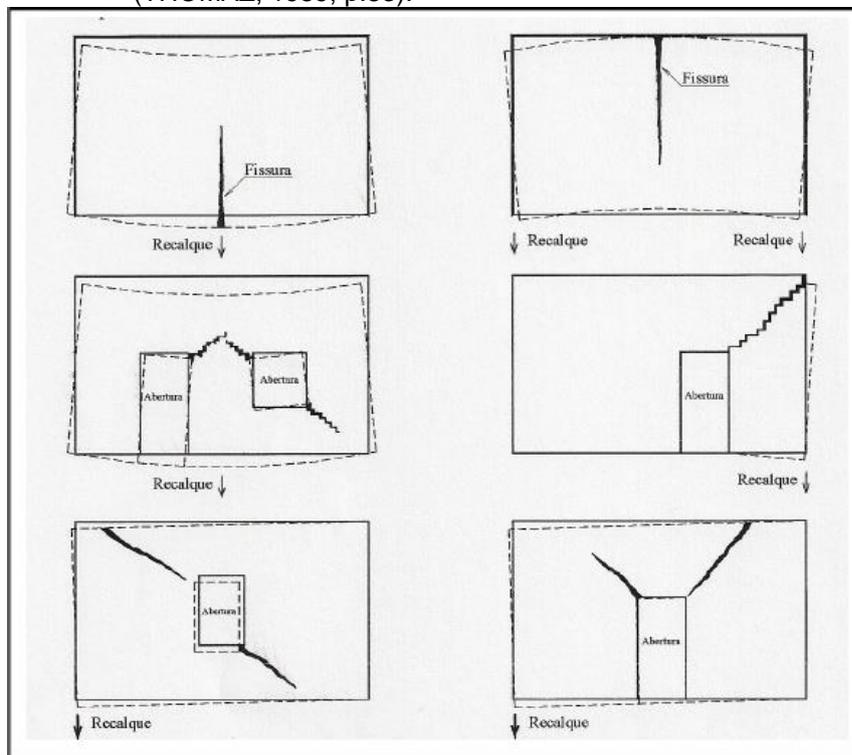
Configurações das fissuras em algumas situações de recalque
